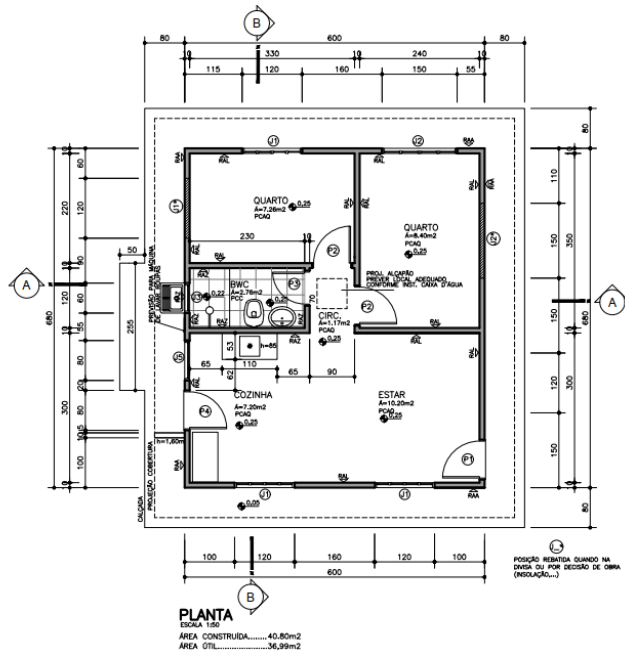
Planta baixa, projeto em estudo, CF 40 G1.
